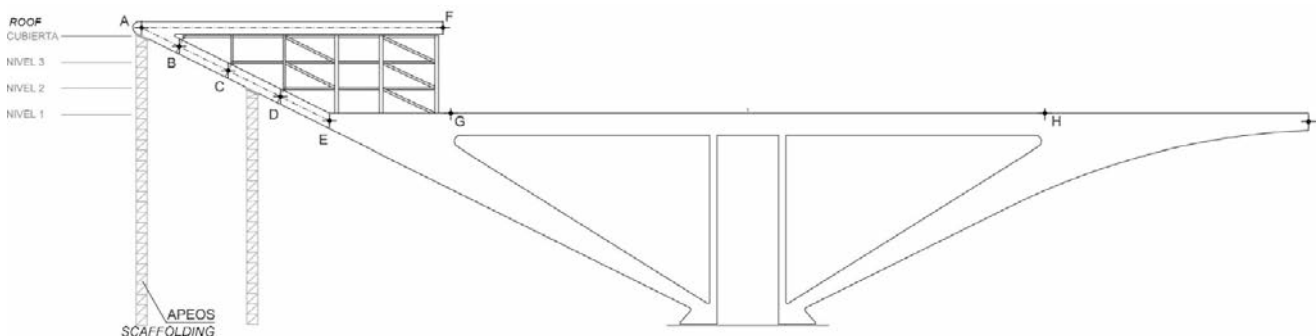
Montaje del voladizo Norte de los edificios de Consejerías
